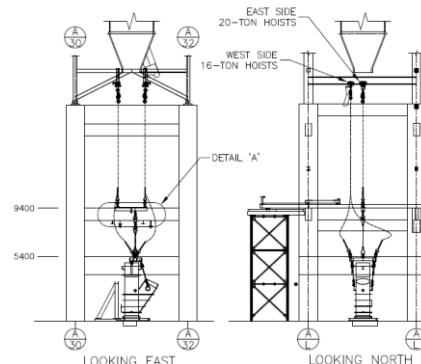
Ingeniería de rigging conceptual izaje Wye Section.
